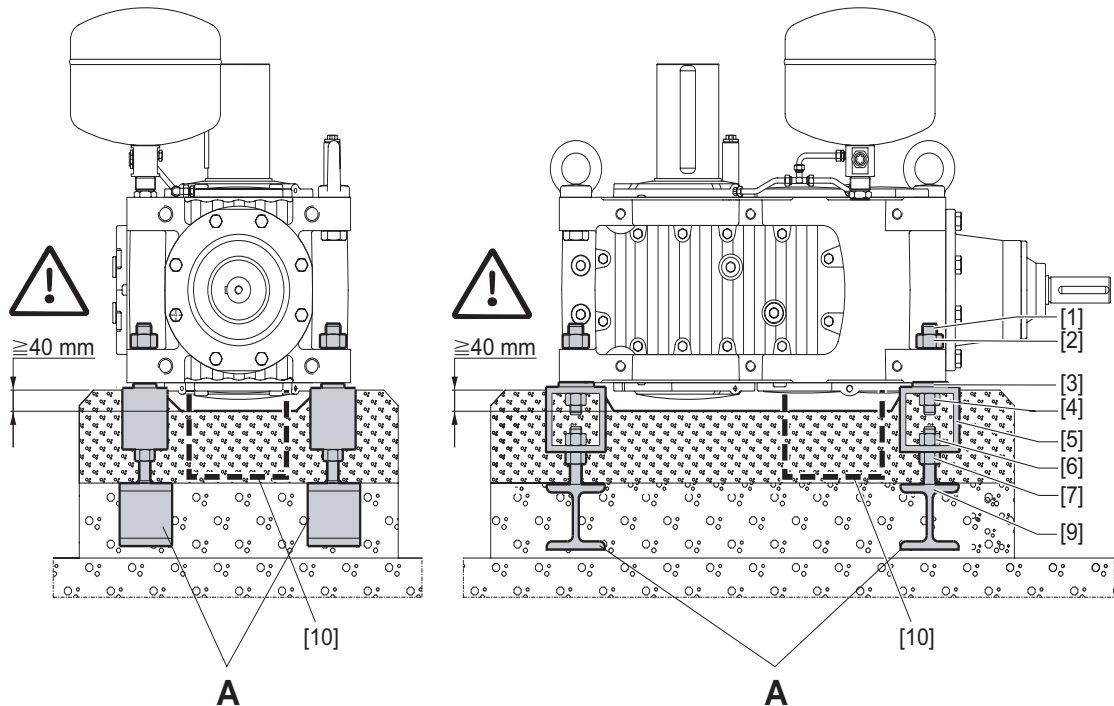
Железобетонный фундамент промышленного редуктора MC.PE.. / MC.RE..
